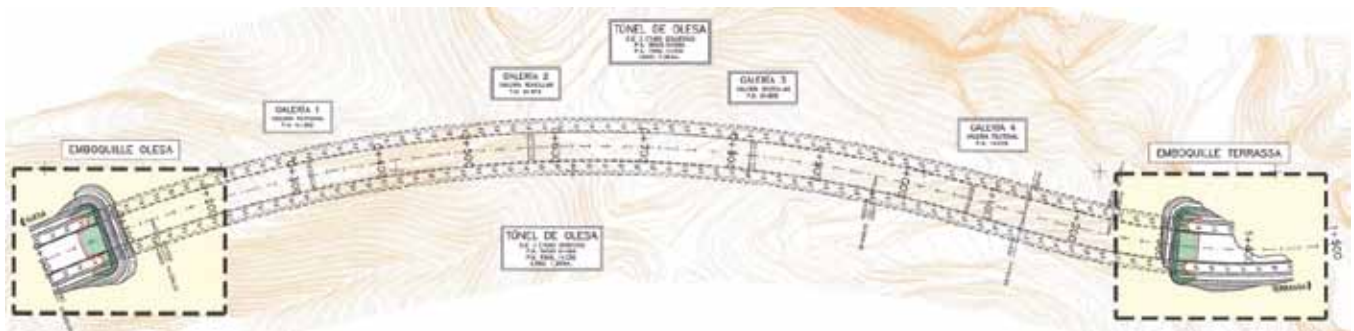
Planta general del Túnel de Olesa (autovía B-40)
